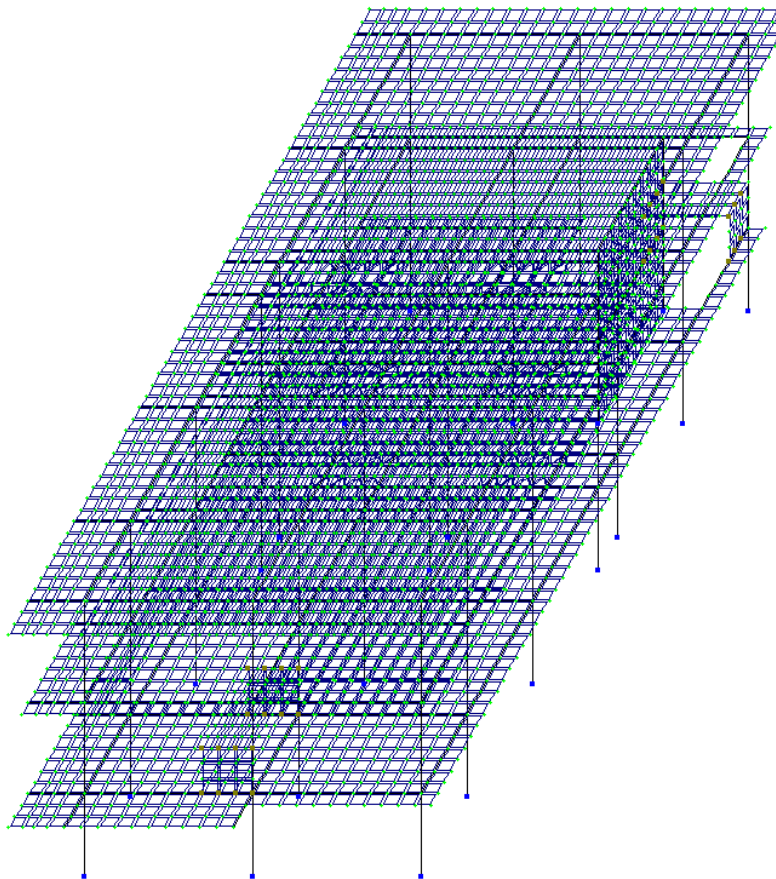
Расчетная схема II-го температурного блока здания
